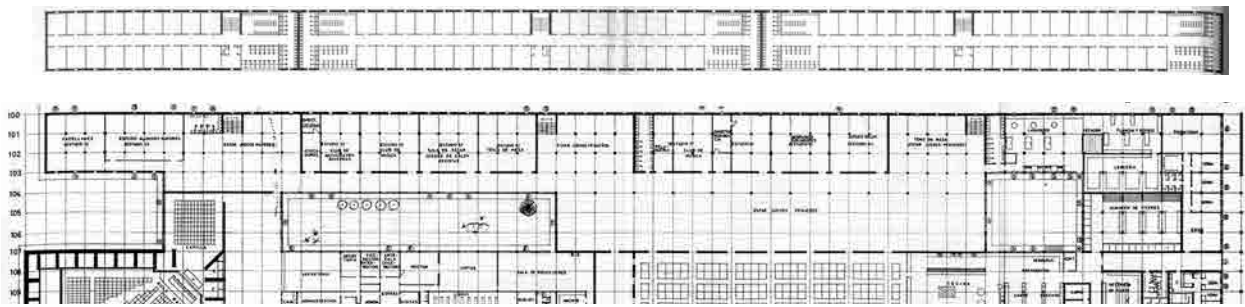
y Fig. 69 Residencias de la Universidad Laboral de Huesca. Planta tipo (arriba) y planta baja (abajo). En la planta baja aparecen partes de otras zonas del programa al tratarse de un edificio compacto.
